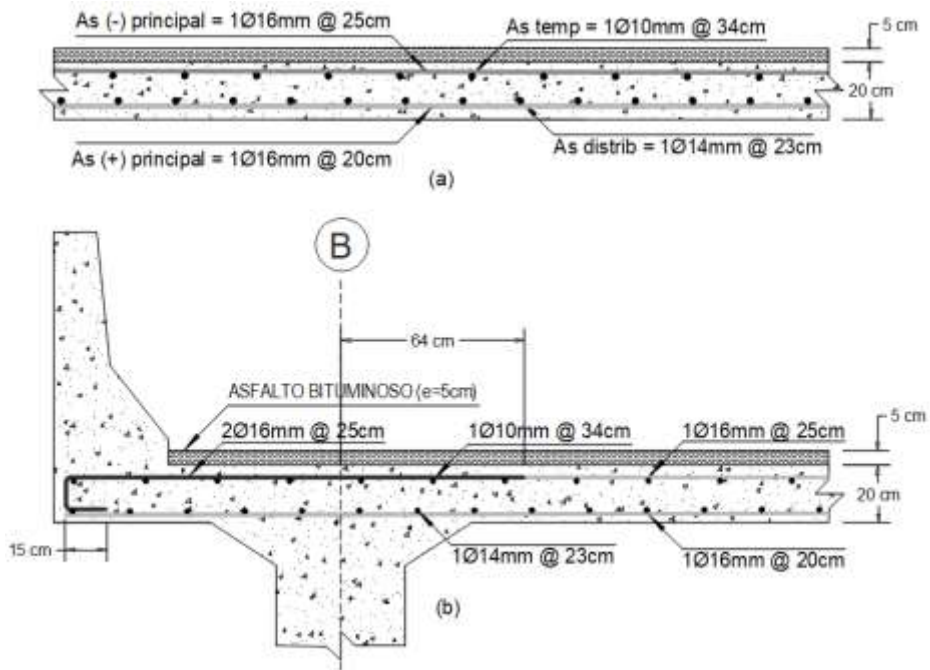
(a) Corte transversal de la losa y (b) Acero adicional para el volado.
